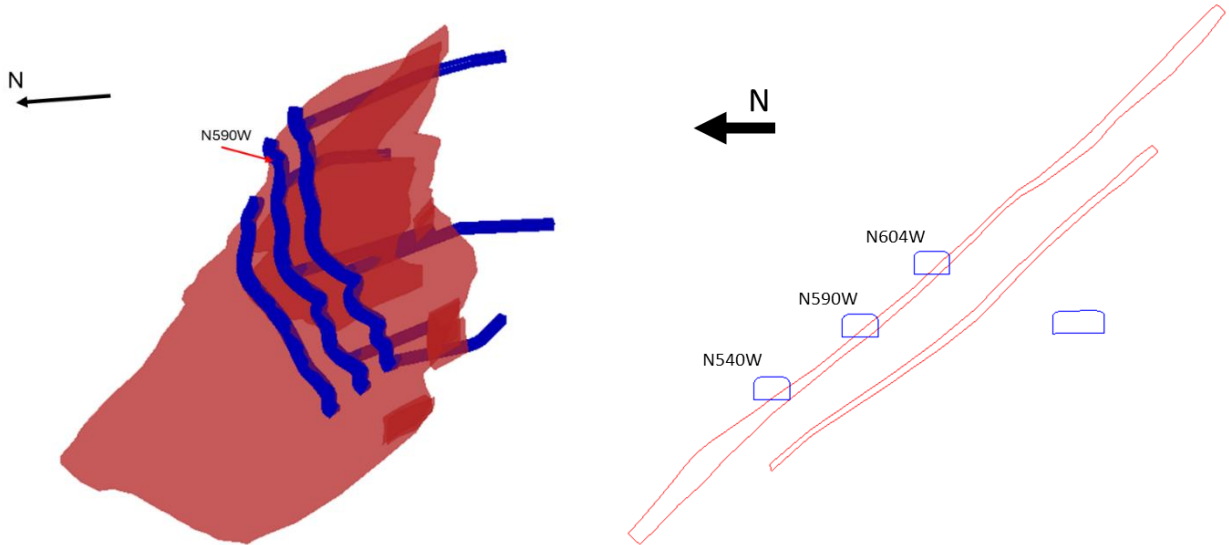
Izquierda: Propuesta de Rebaje 590W y 604W para la explotación de mineral mediante el sistema de barrenación larga. Debajo del N590W el proyecto para nivelar elevación del rebaje 540W. Derecha: Sección N-S con vista al oriente de la traza mineral (rojo) con las propuestas de rebajes (azul).
